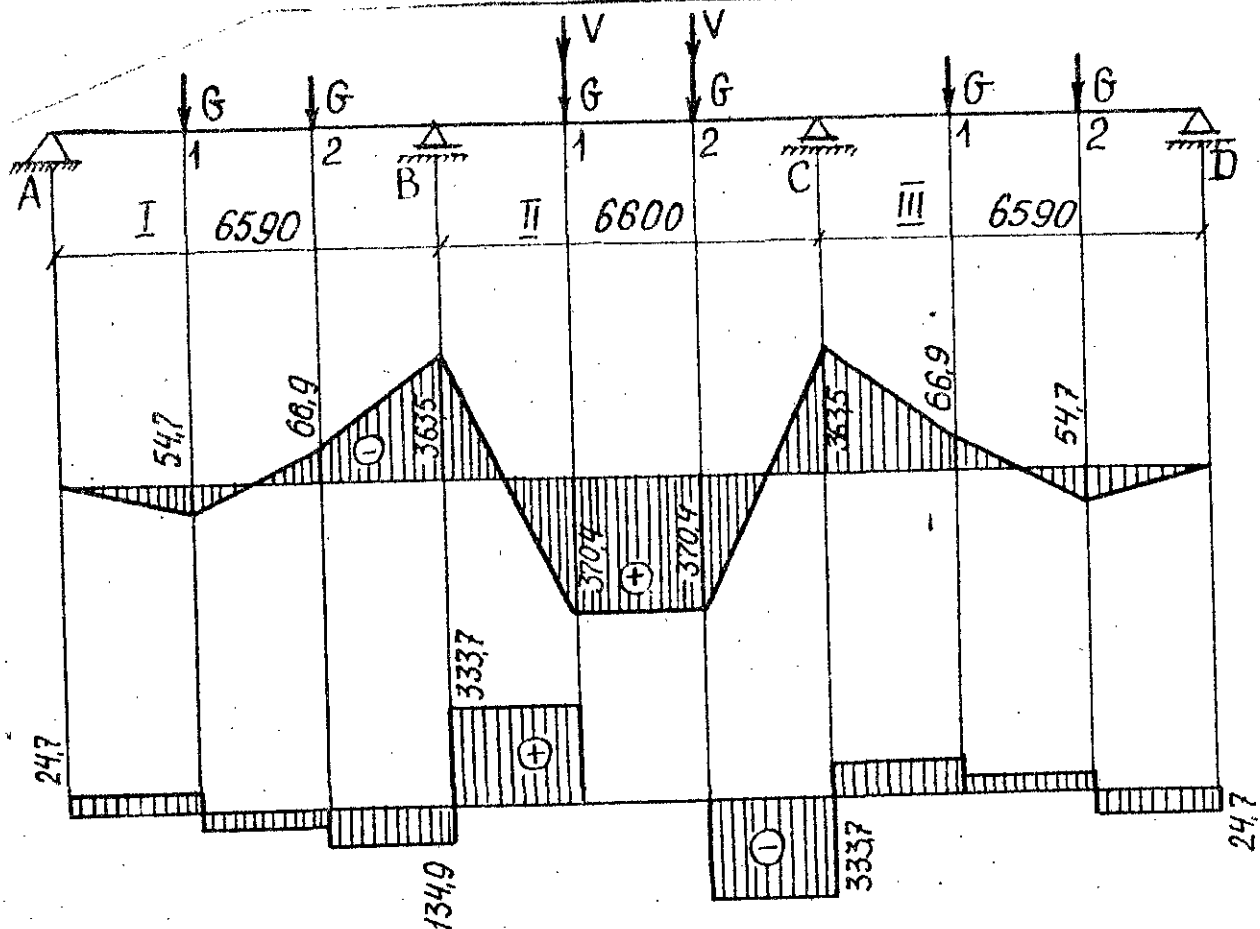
Расчетная схема, эпюры M и Q при 2-й комбинации нагрузок
